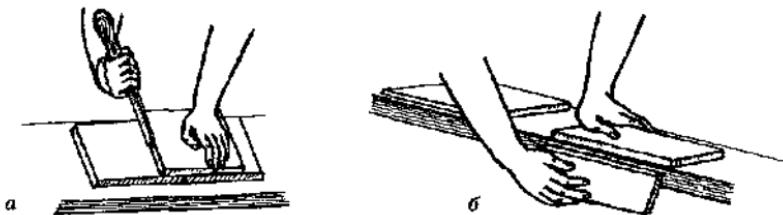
Подготовка плиток: а — резка; б — раскалывание по разметке
